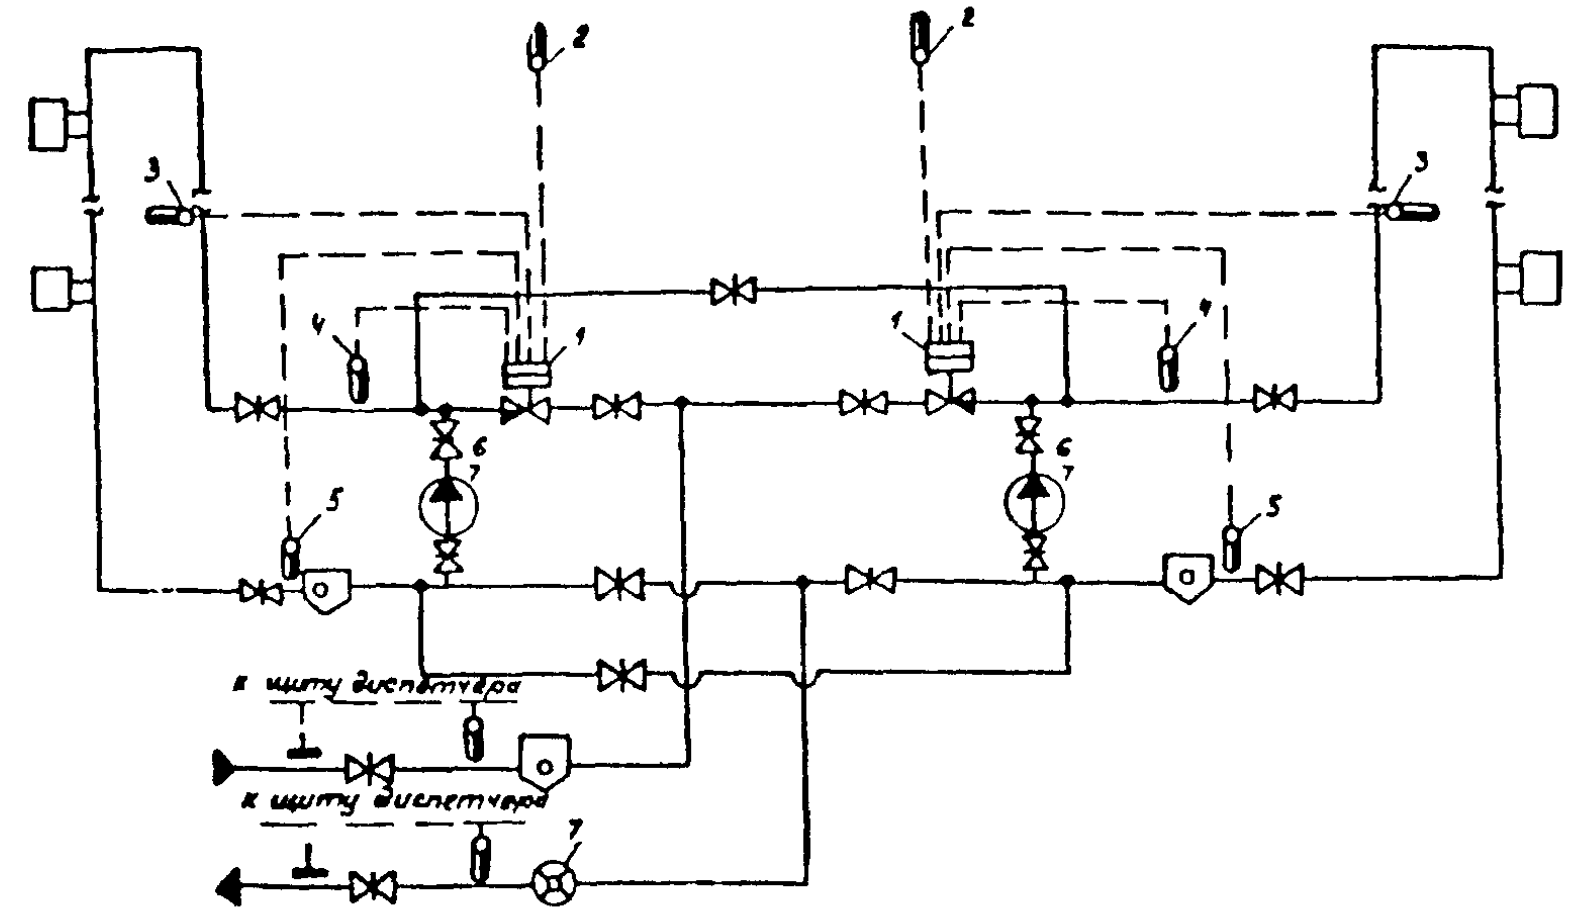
Технологическая схема пофасадной автоматизации системы отопления с насосом на подающем трубопроводе
